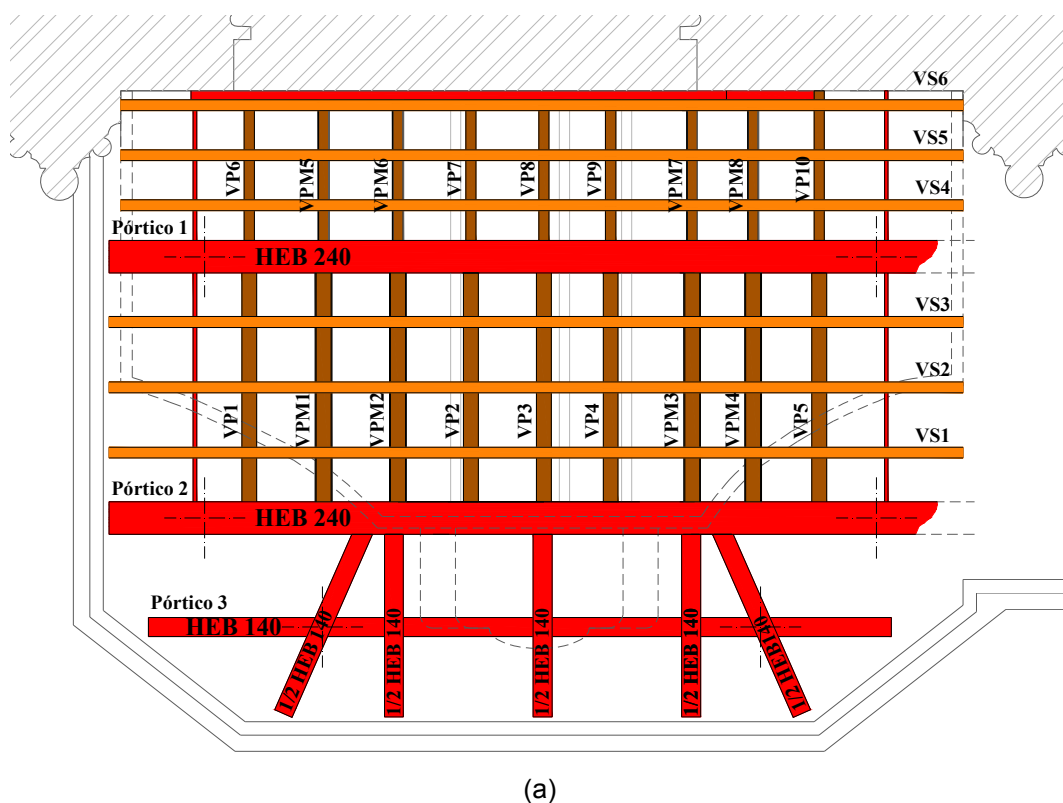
Planta do reforço do vigamento do pavimento do coro alto em zona de colocação do órgão.
